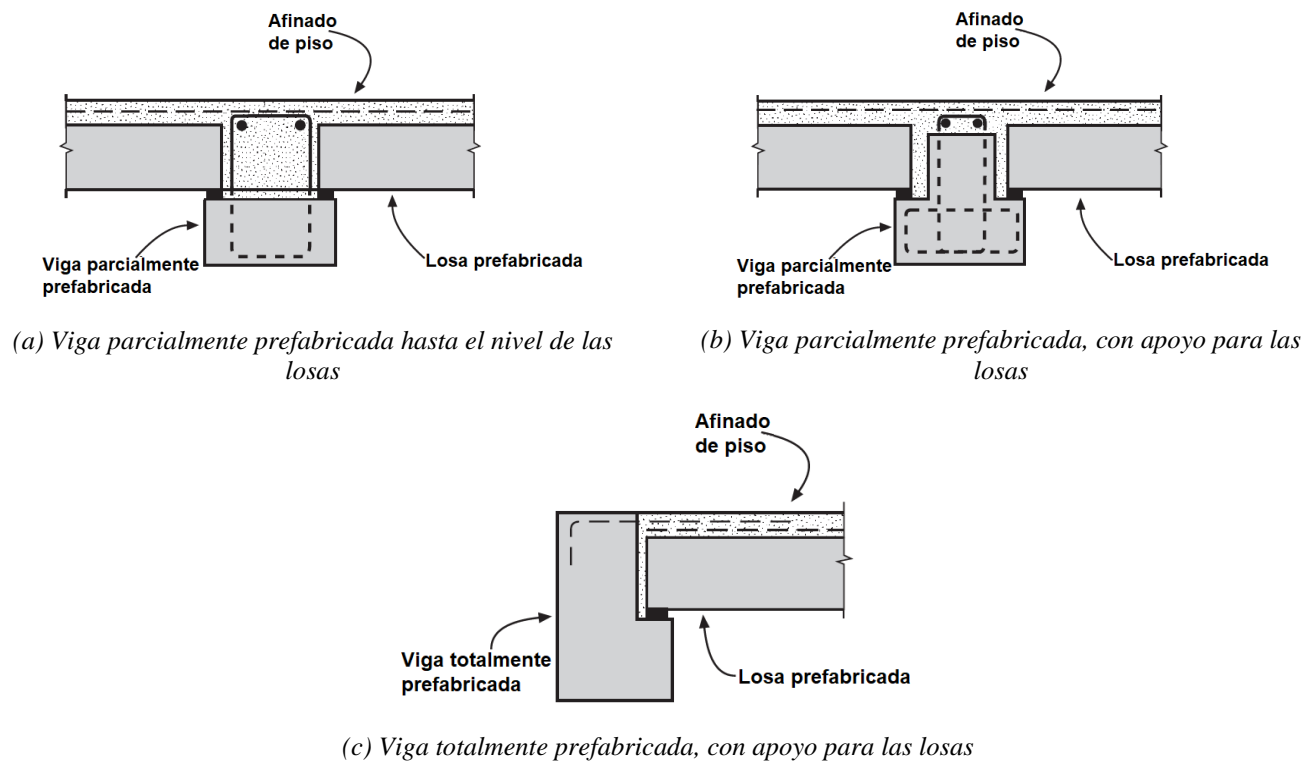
Ejemplos de vigas utilizadas como soporte para losas. Adaptado de CAE (1999).
